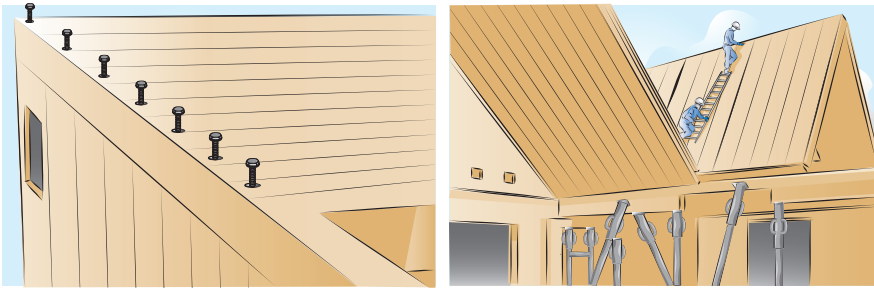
Panneaux en CLT utilisés en plancher et en toiture
